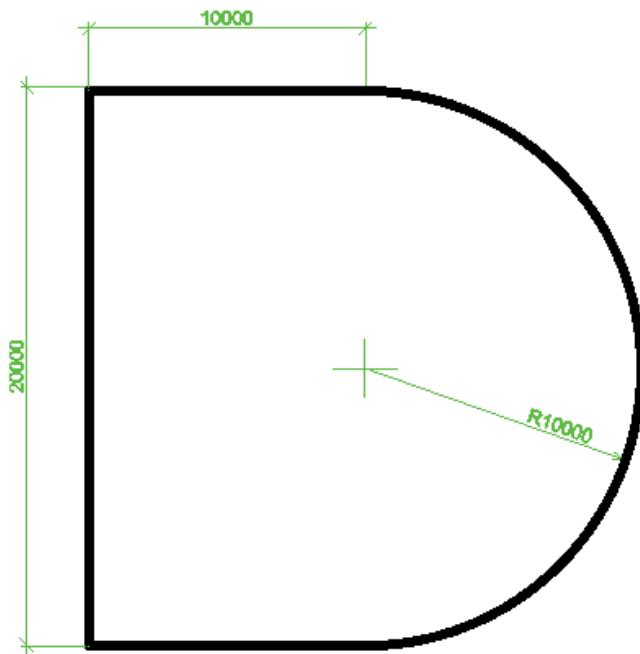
Круглое здание с двумя прямыми углами
